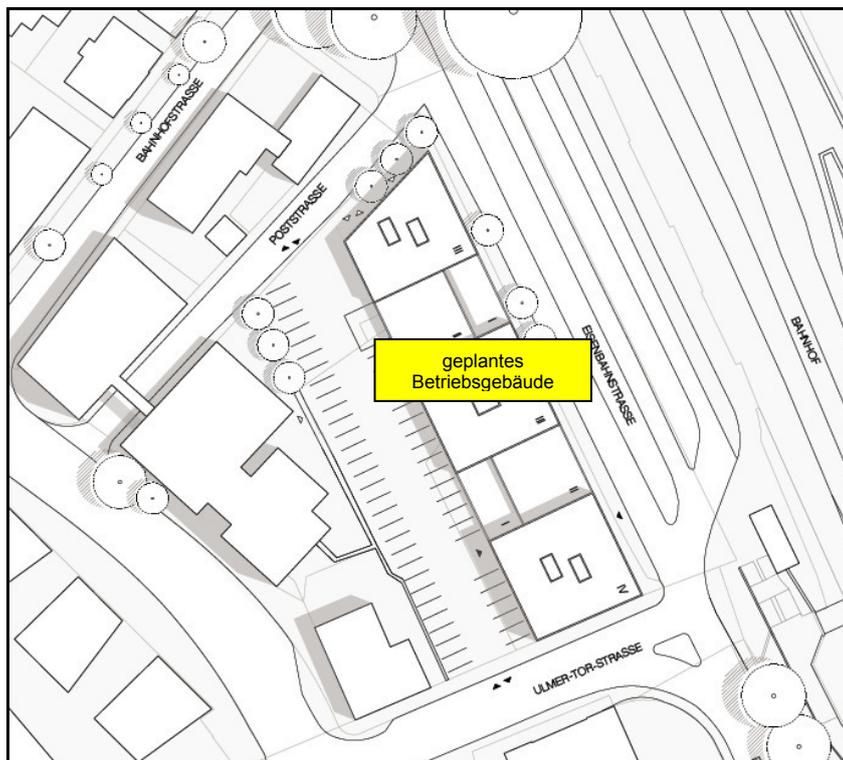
Lageplanausschnitt mit Darstellung des Bauvorhabens gemäß [a]
